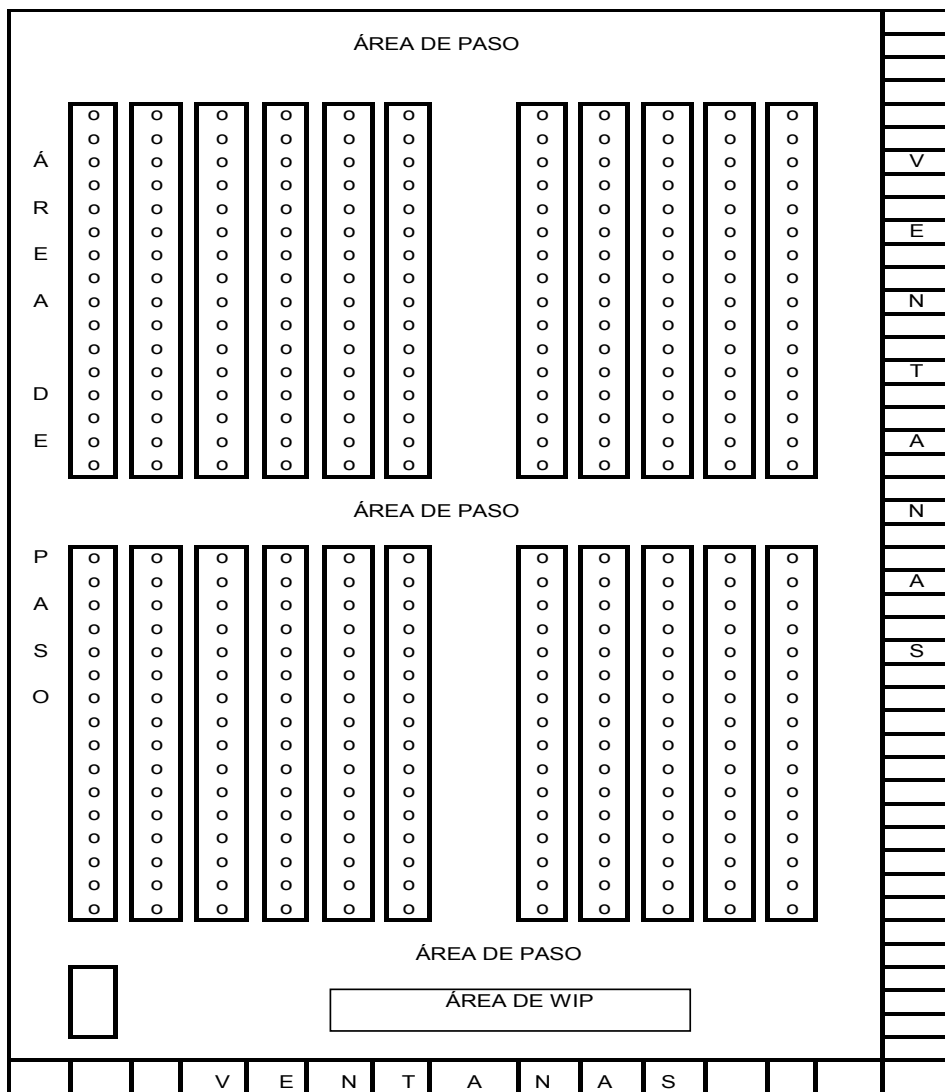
Plano de iluminación y ventilación del área de tendido y corte
